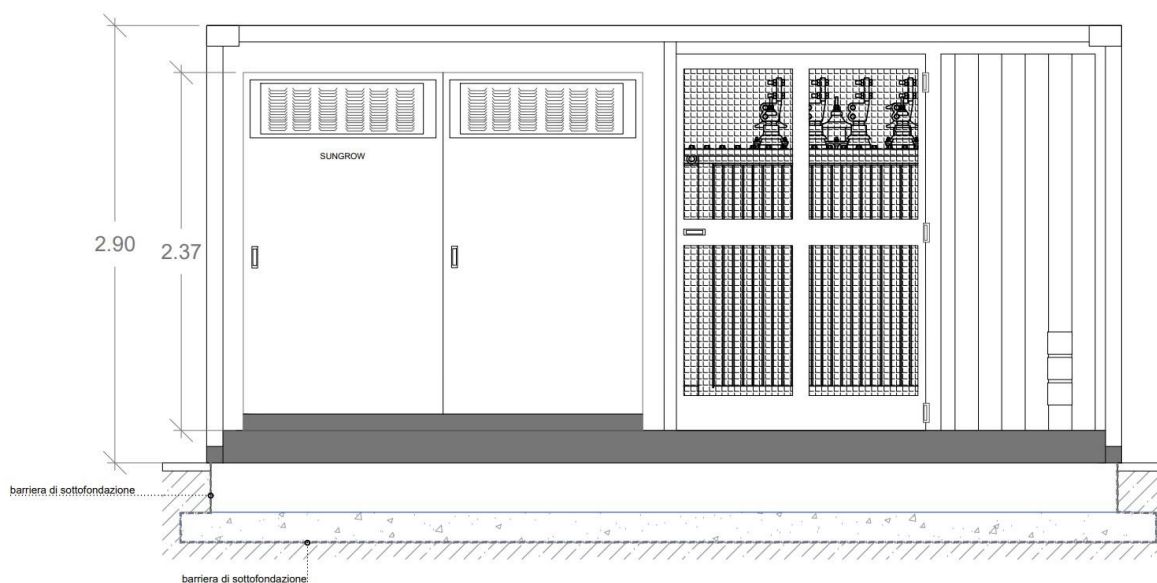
Pianta struttura di fondazione cabina di sottocampo
